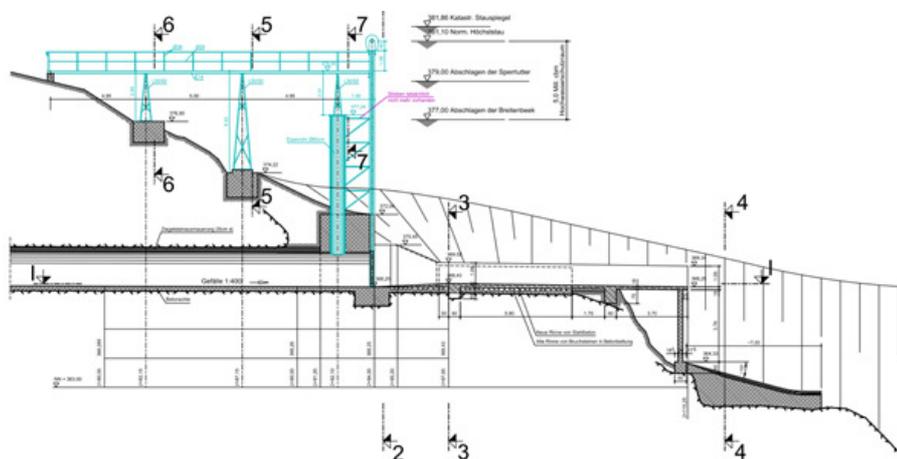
Hillebille-Stollen Auslaufbauwerk Längsschnitt
